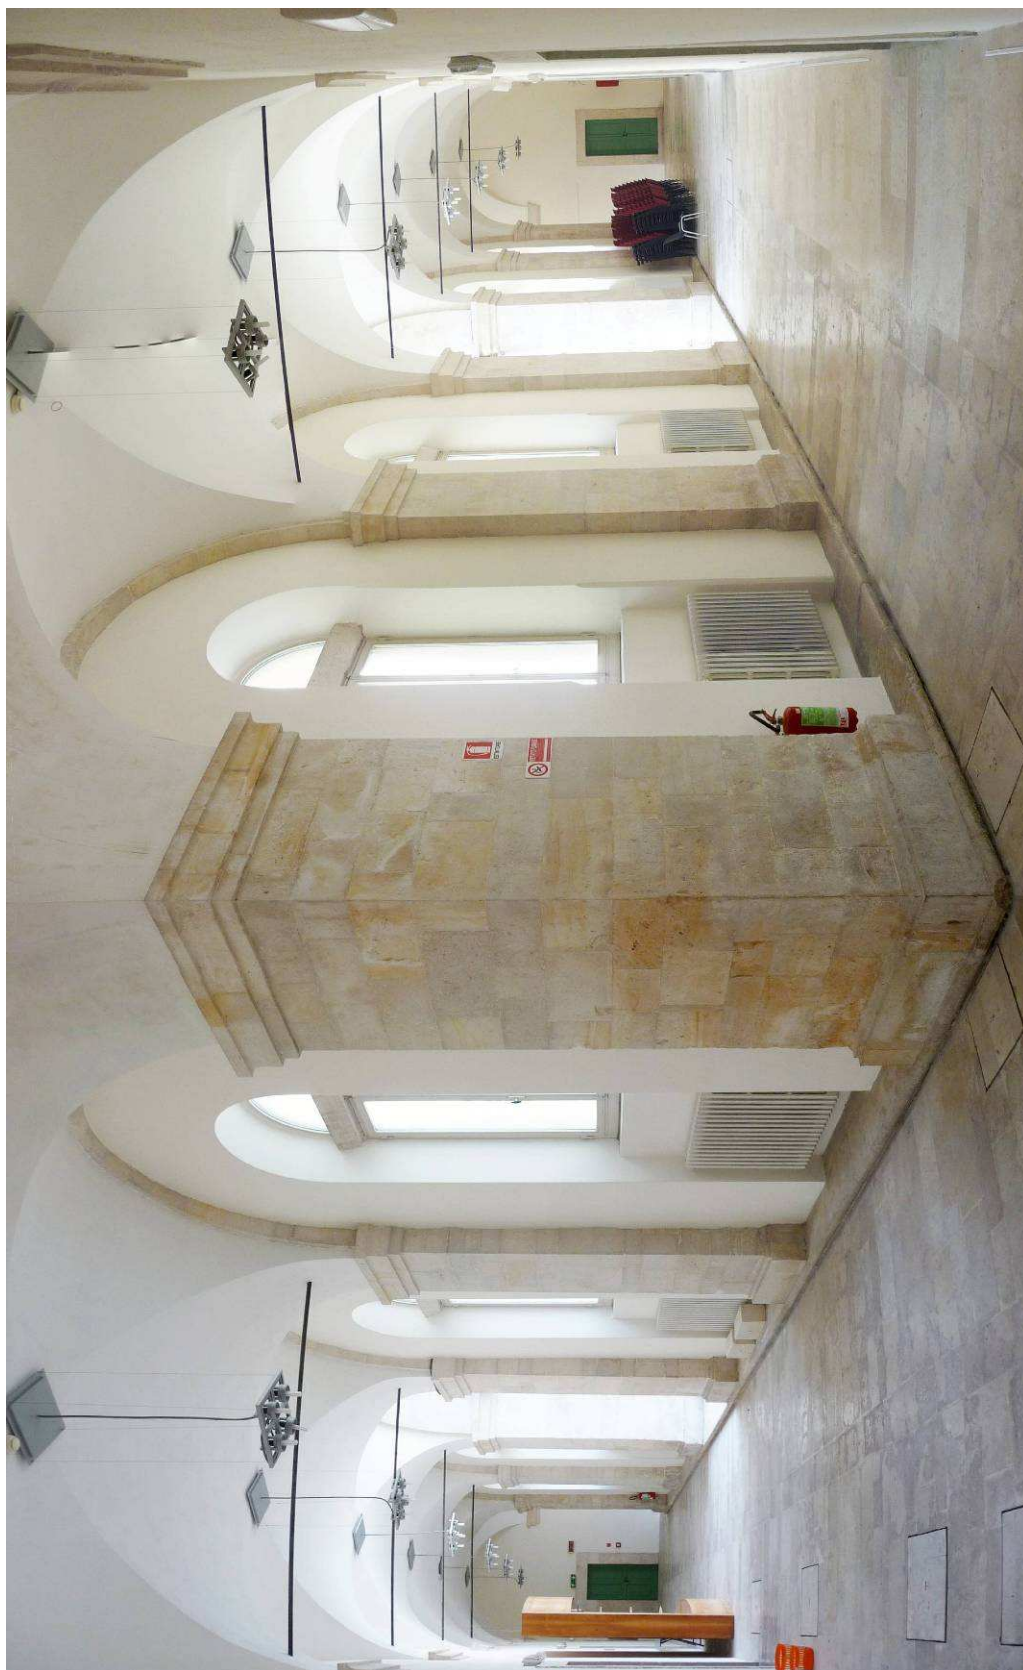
Piano terra, ali sud ed est del chiostro. In primo piano al centro, in corrispondenza del pilastro d'angolo, si nota l'umidità dovuta all'infiltrazione dell'acqua piovana.
